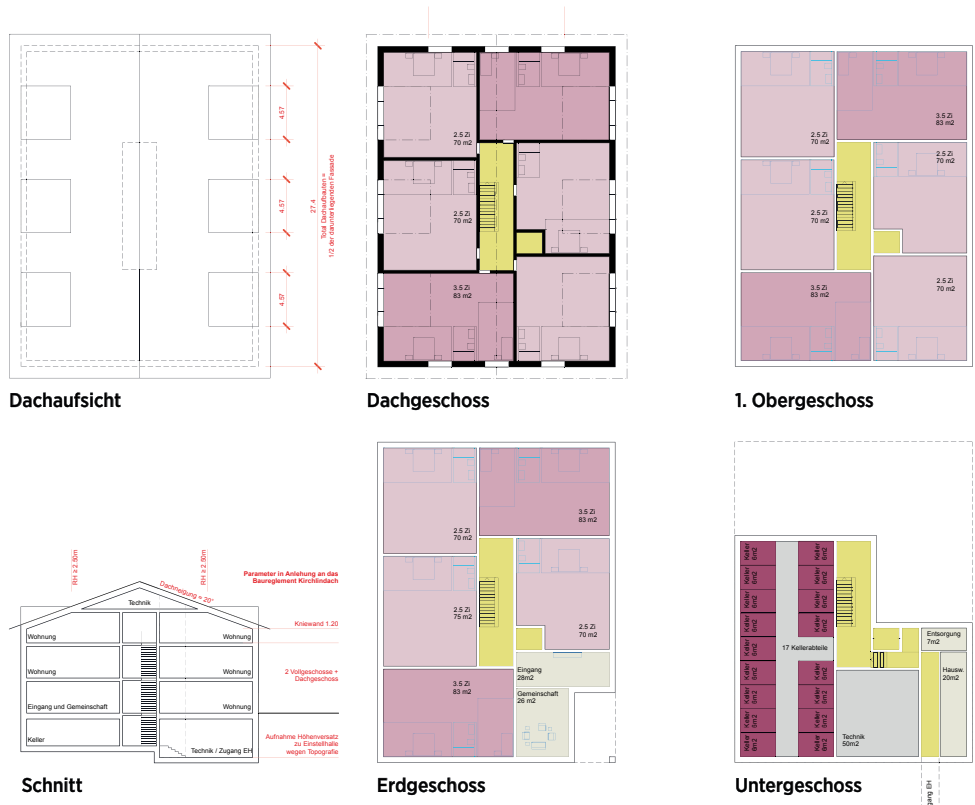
Grundriss und Schnitt Alterswohnen (Bearbeitungsteam)
